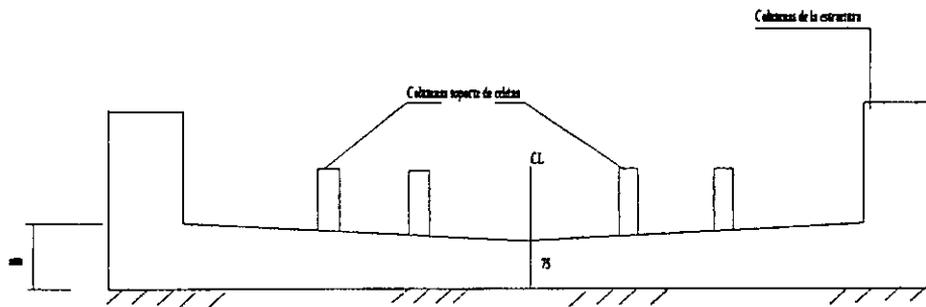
SECCIÓN TRANSVERSAL LOSA DE CIMENTACIÓN
